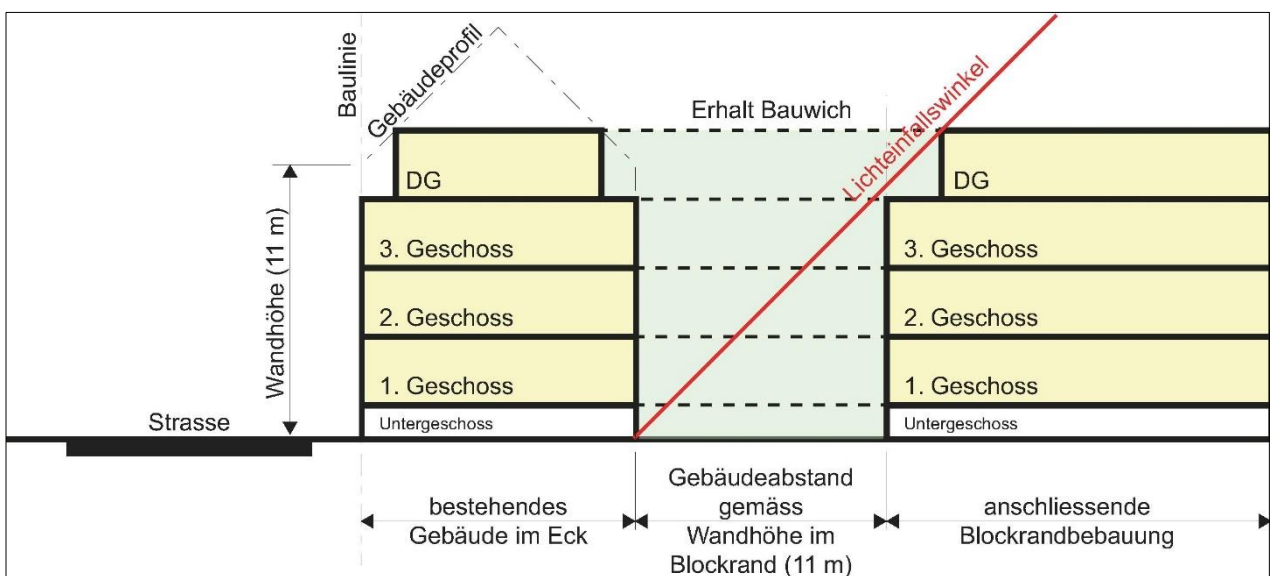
Erhalt Bauwuch: Beispiel der Bebaubarkeit gegen ein Gebäude in Ecklagen in der Zone 3. Grün ist der heute bebaubare Bereich der künftig freigehalten werden müsste.
